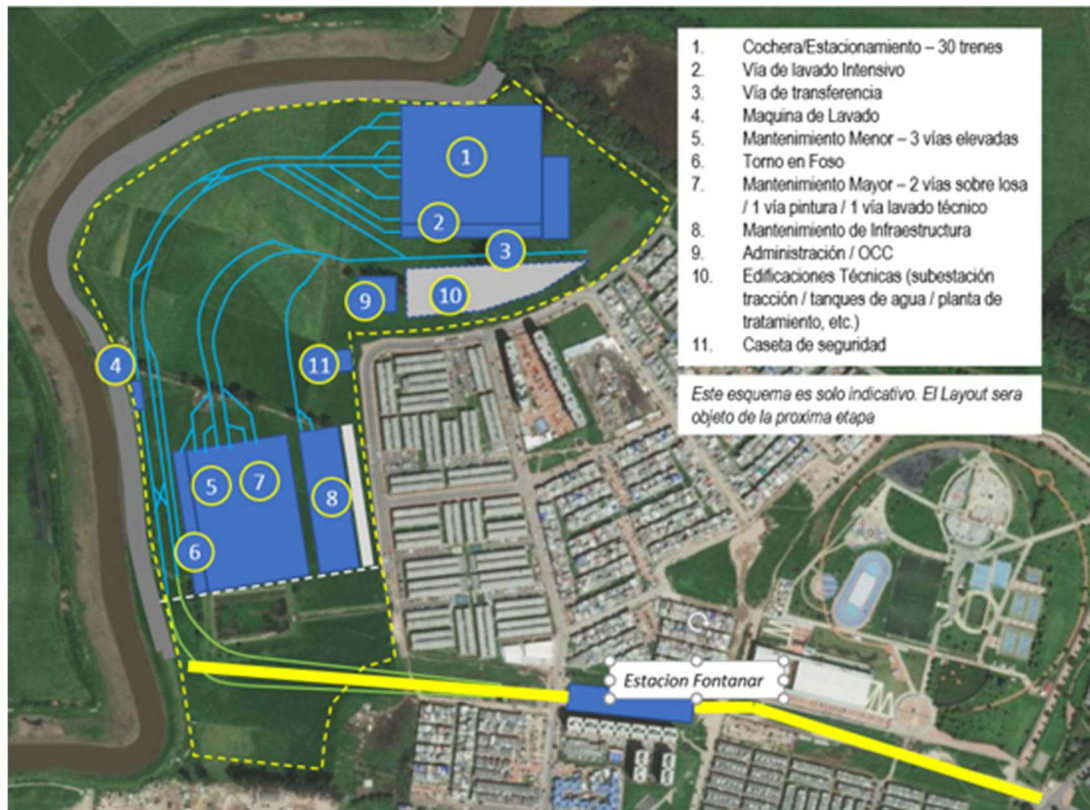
Implantación de estructuras proyectadas en el patio taller.
